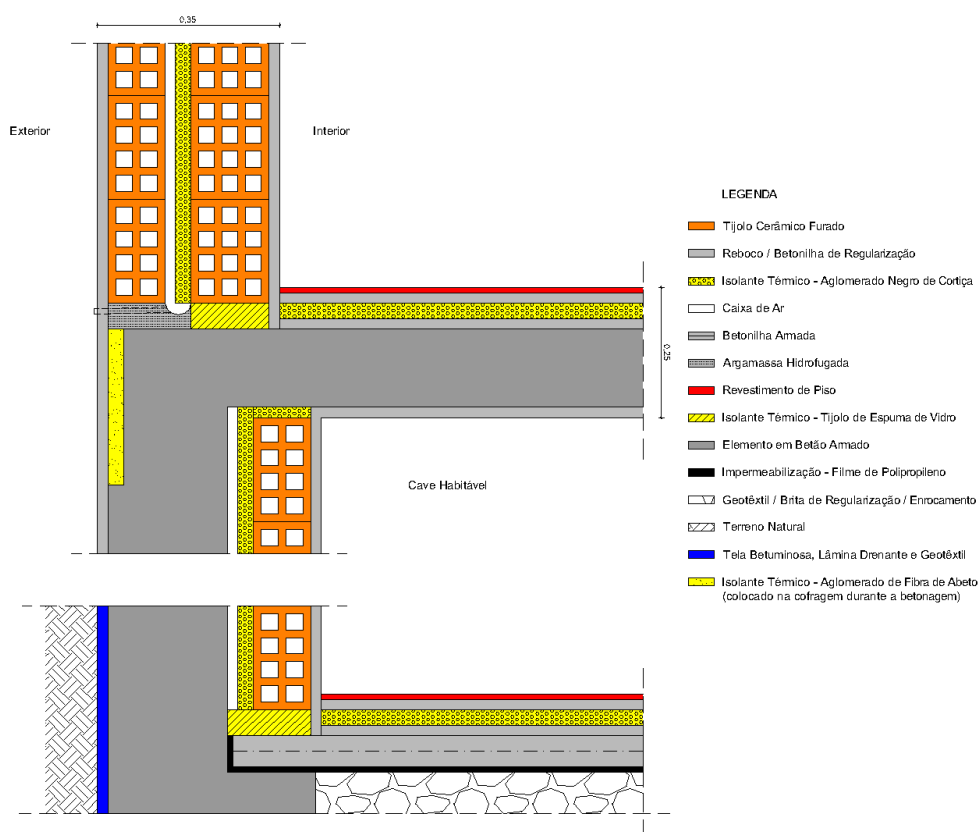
Ligação da fachada com cave habitável, adaptado de [10]
